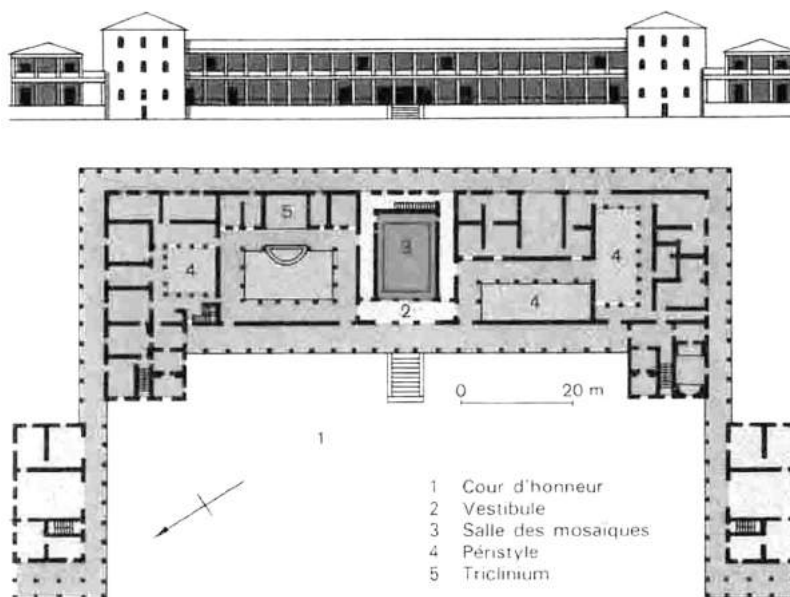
Villa romaine, Luxembourg : Plan et façade
